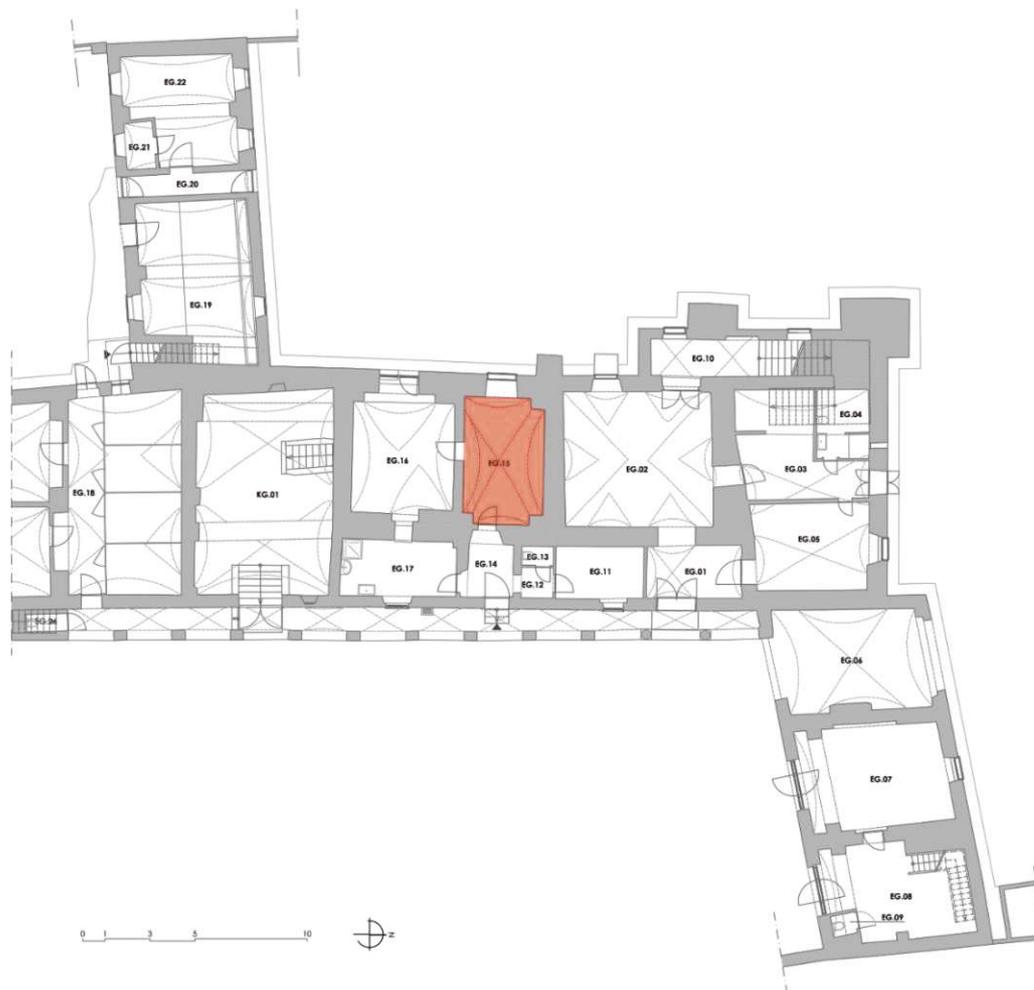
Erdgeschoss Übersichtsplan- EG.15
